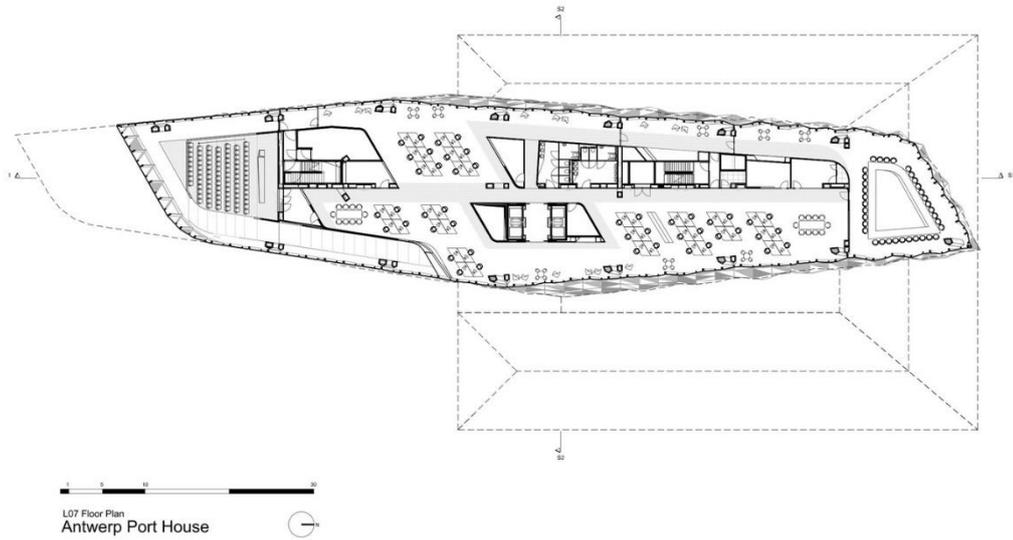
Plano Planta de Coworking Oficinas portuarias de Amberes,
